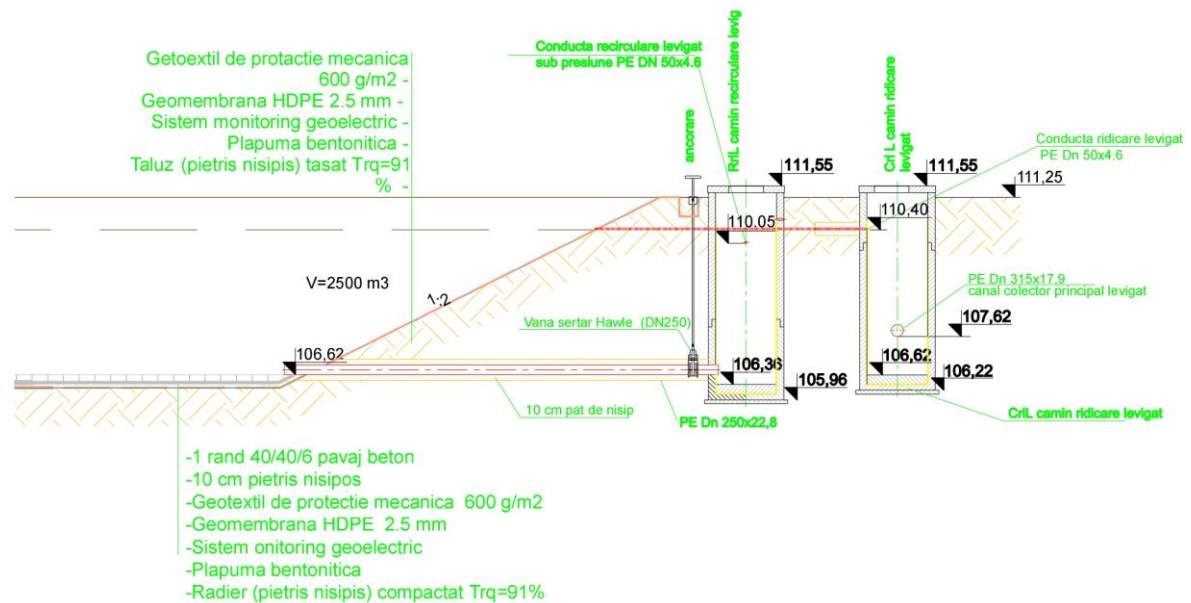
1. Schema bazinului de colectare levigat
